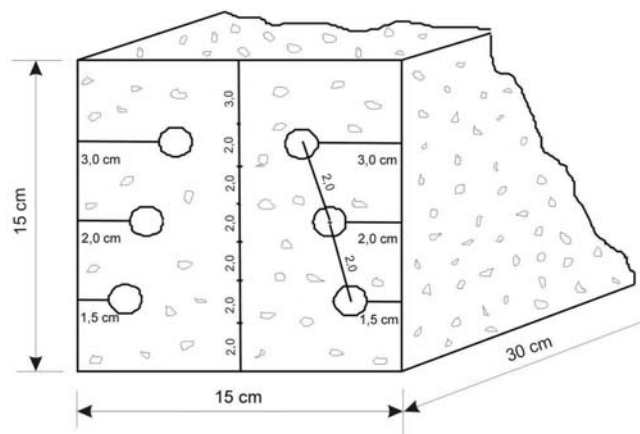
Esquema indicativo da seção dos corpos-de-prova armados, verificando-se a diferença das espessuras de cobrimento das armaduras (1,5cm, 2,0cm e 3,0cm).
